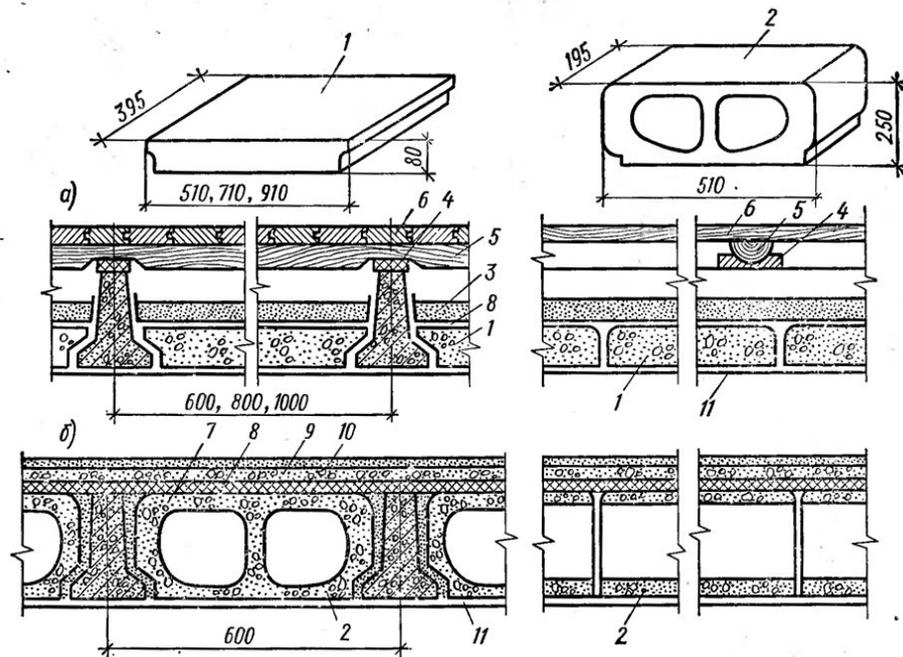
Сборное железобетонное балочное перекрытие:
